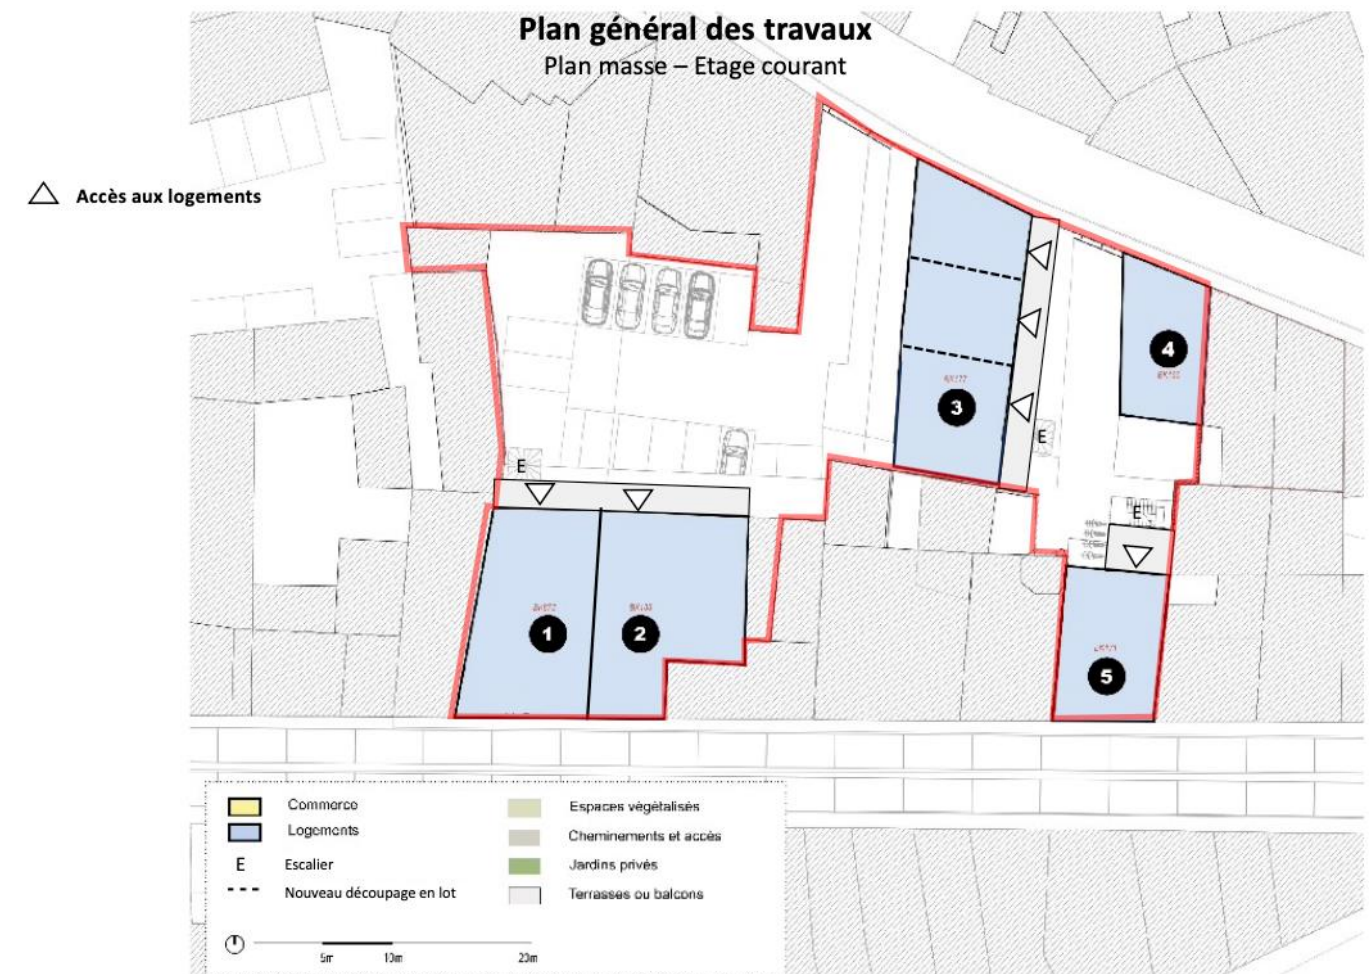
Plan masse – Niveau des étages courants du projet retenu
